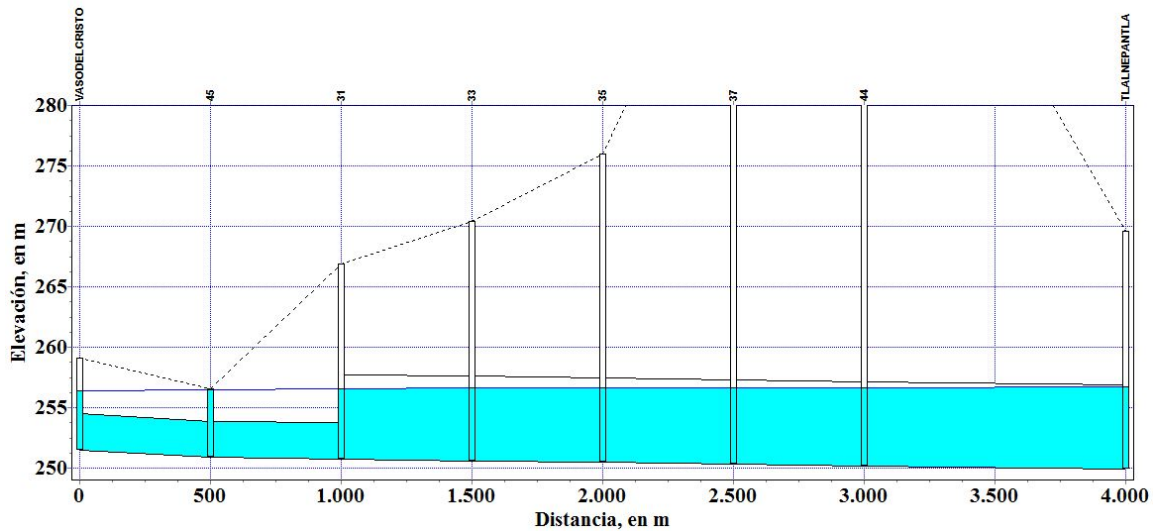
Perfil túnel nuevo con cajón al primer kilómetro. Alternativa 4
